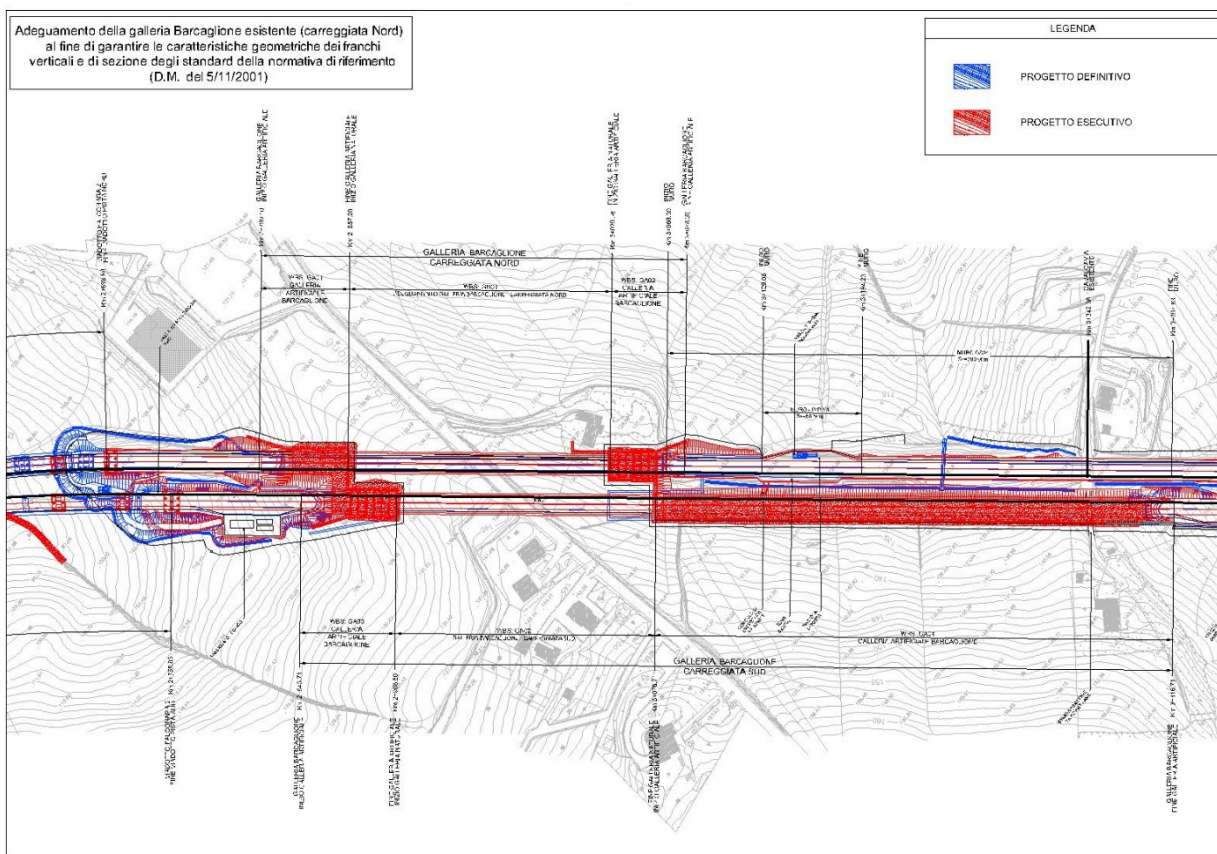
Sovrapposto planimetrico tra PD e PE nella zona Intervento 3 (galleria Barcaglione)
